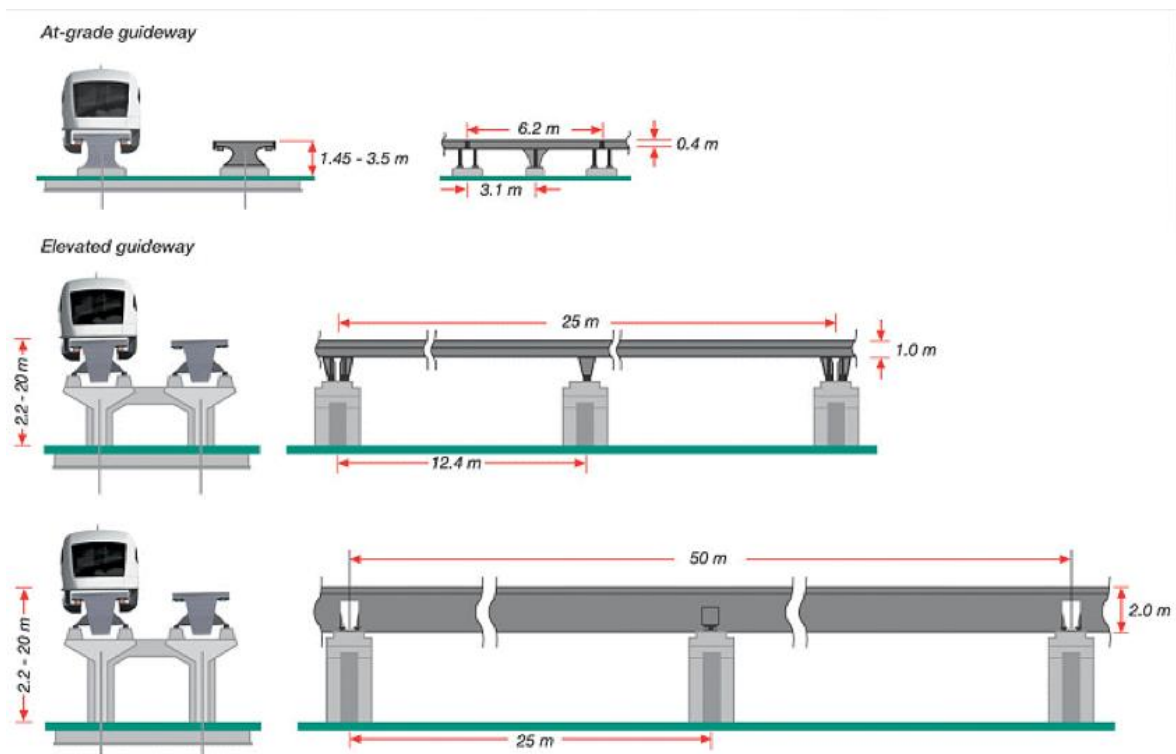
Características da *guideway* do sistema *Transrapid* (Fonte: (ThyssenKrupp, 2008))
